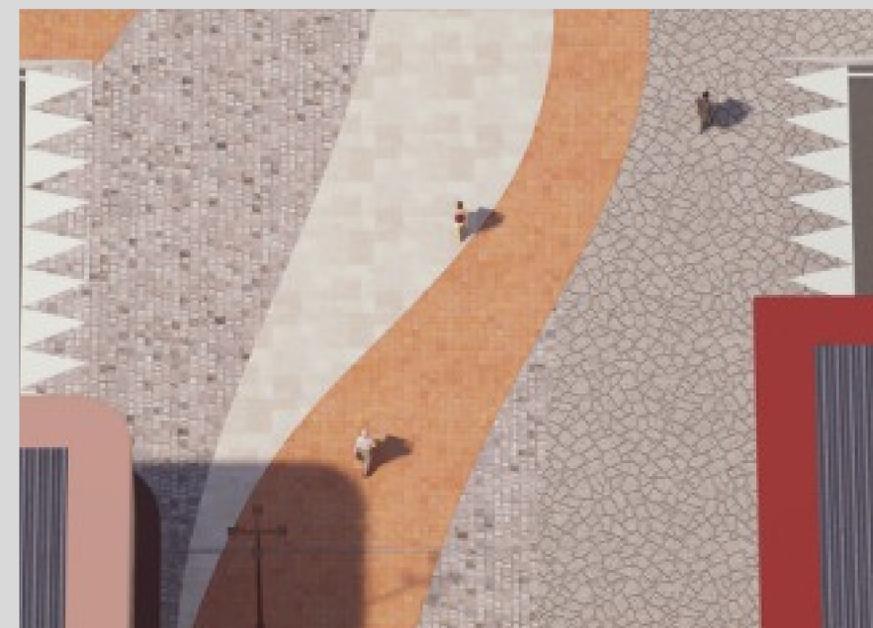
VISTA SUPERIOR RAMPA ELEVADA NA TRAVESSA GARAPEIRA
